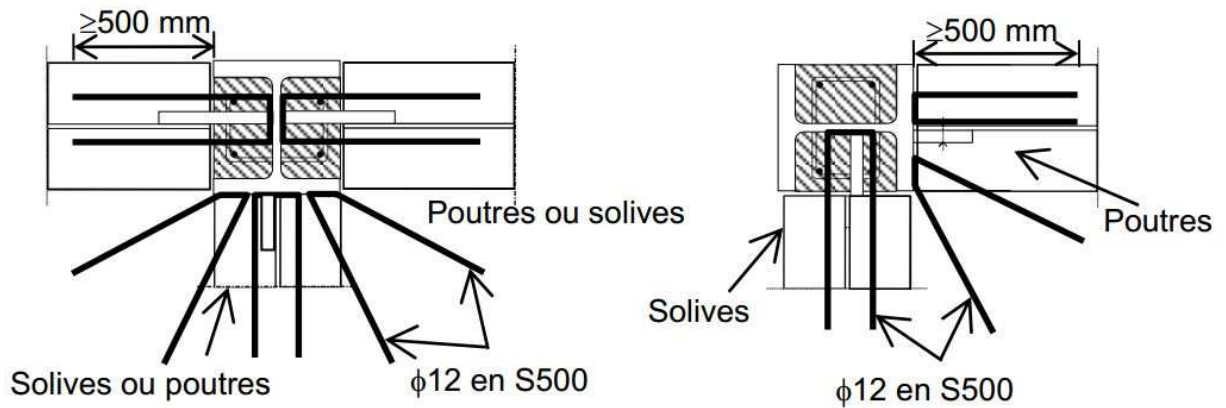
Liaison entre armatures additionnelles et poteaux de rive
